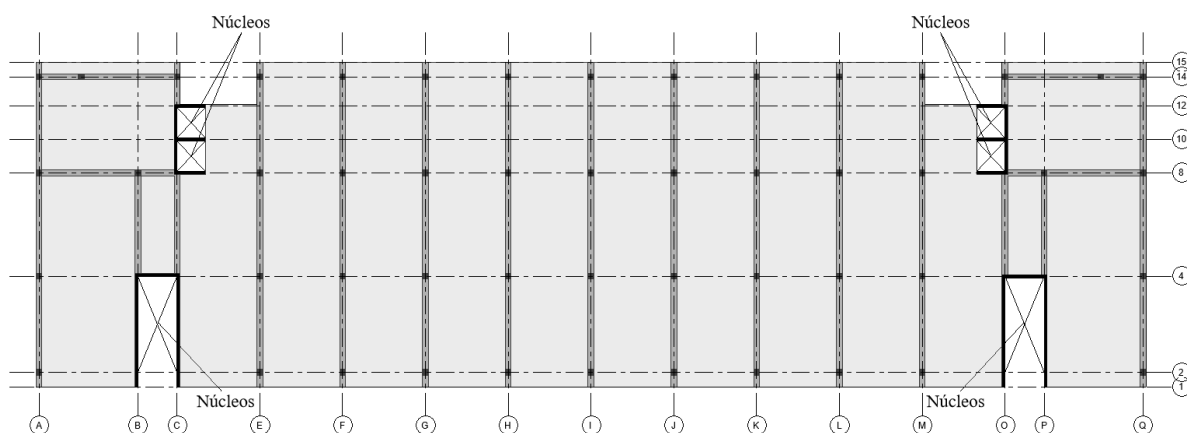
Configuração estrutural do 1º piso, com vigas, colunas, núcleos e lajes, do edifício em aço da classe estrutural S355 com núcleos de betão armado
